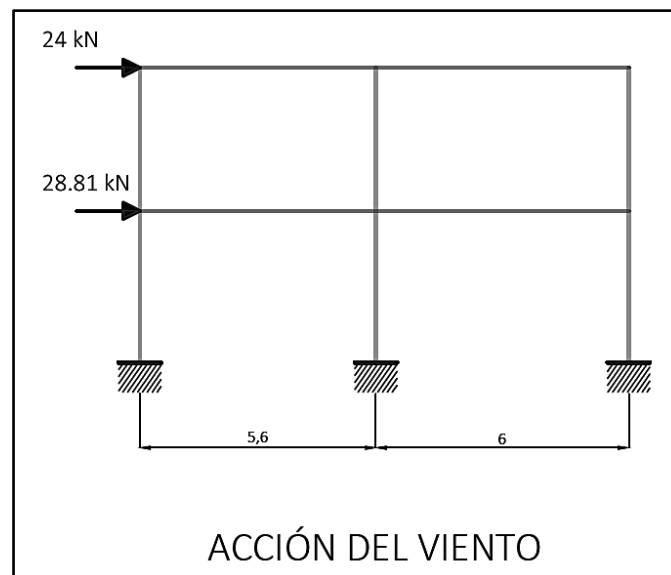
Acción del viento total sobre la fachada a barlovento. Pórtico B. (cotas en metros).
